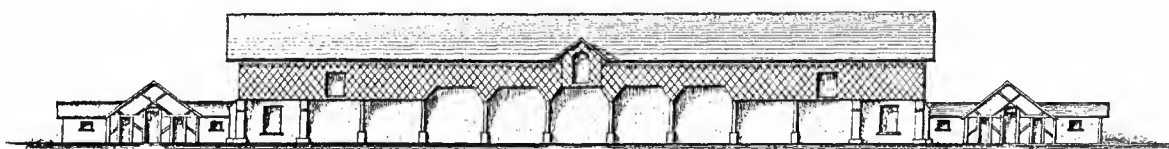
Coupe en longueur de toutes les constructions de la ferme.
